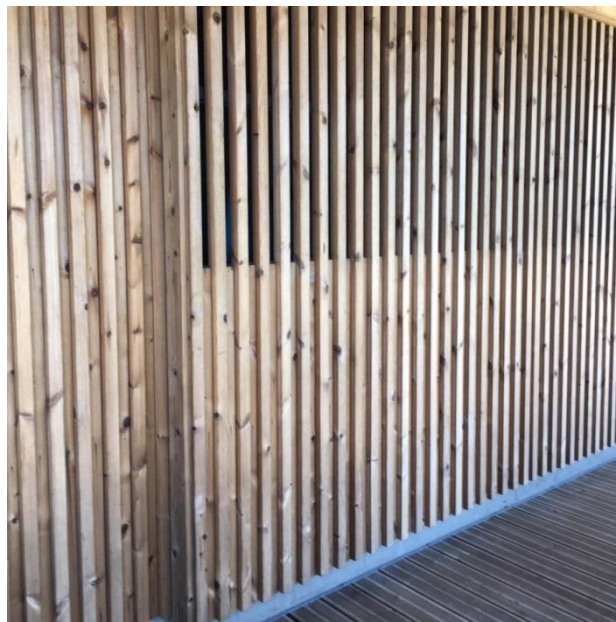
ESTILO DE FACHADA PARA EQUIPAMIENTOS
